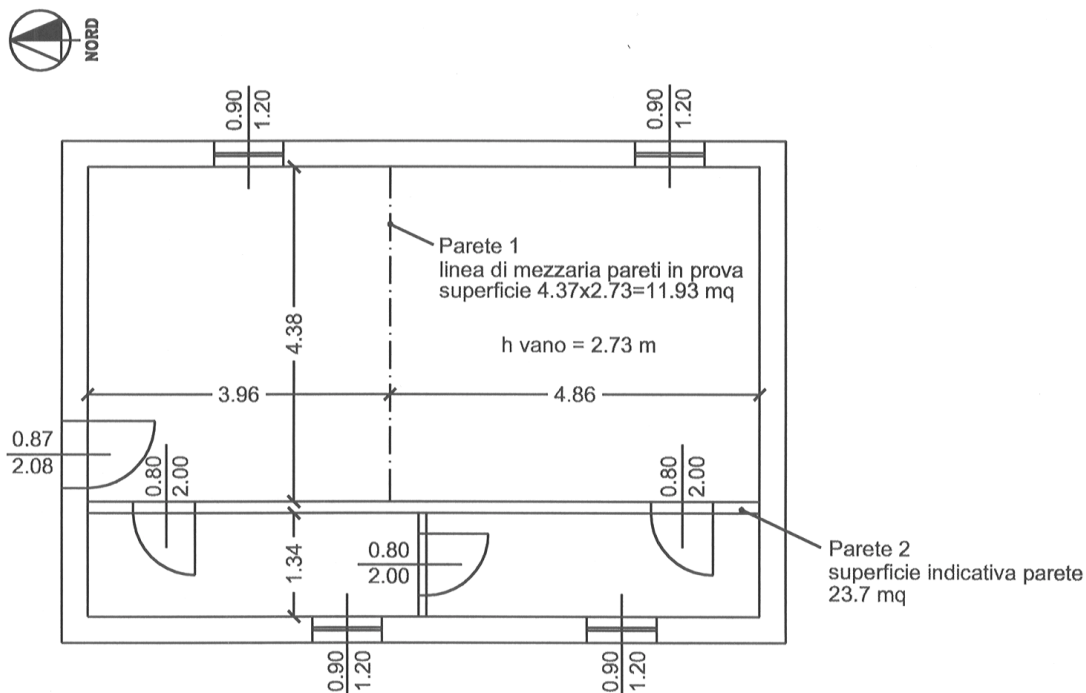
pianta del Laboratorio Sperimentale Aperto di Trento.
